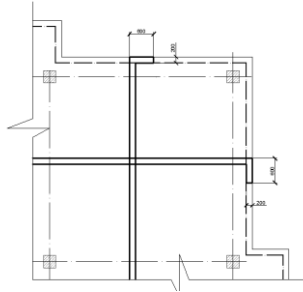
Схема расположения балок усиления плит перекрытий, по периметру плиты перекрытия
